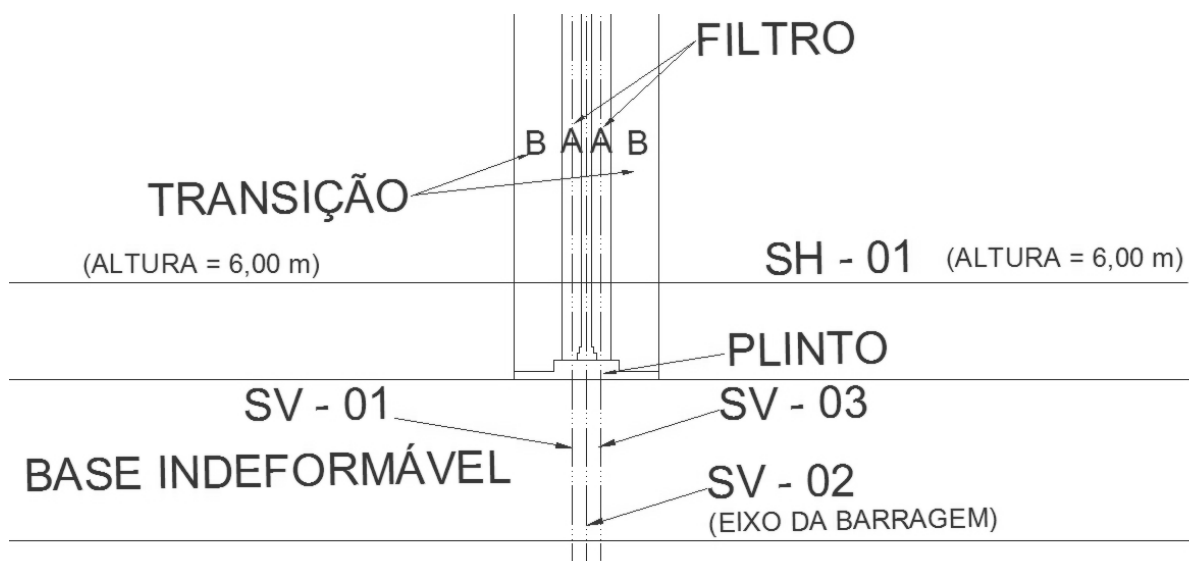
Detalhe do plinto da barragem e as seções verticais consideradas.
